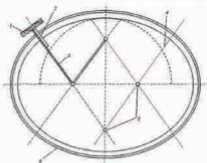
Выполнение овальной тяги воробей-вожжницами: 1 — ползкок; 2 — радиусная рейка; 3 — упор; 4 — профильная доска; 5 — верстак; 6 — готовая тяга; 7 — линии разметки; 8 — центральный штафт
